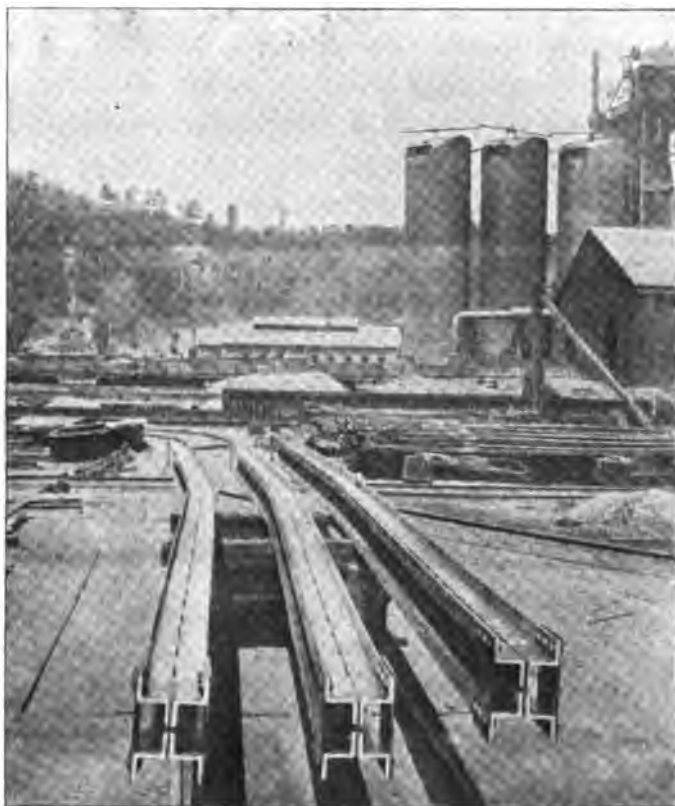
Colonnes en fers Z, rompues aux ateliers de la Keystone Bridge Co. (Essais de M. C. L. Strobel).
